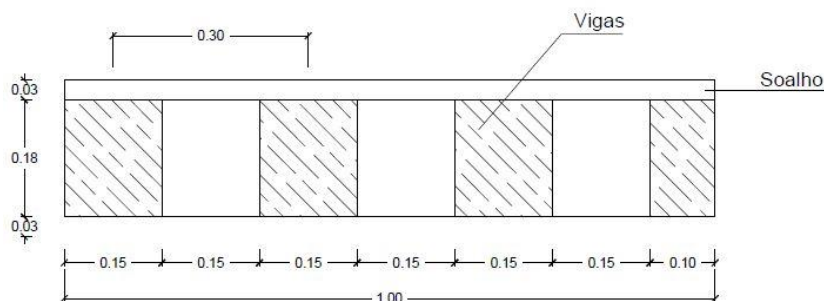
Corte típico pavimento com dimensões em metros retiradas da bibliografia
